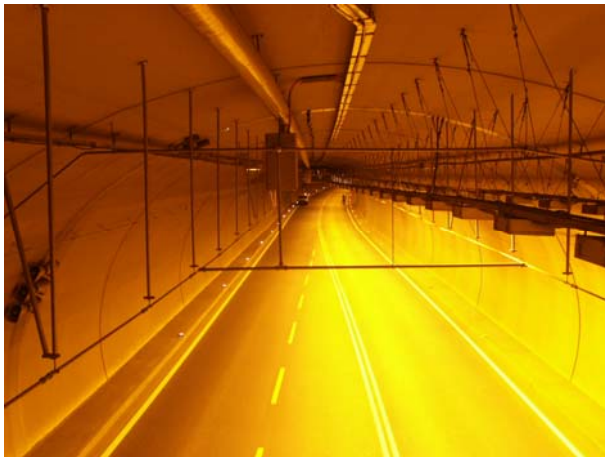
zeigt das Tunnelprofil mit dem fertig montierten Rohr- und Düsensystem des Wassernebel-Brandbekämpfungssystems.
